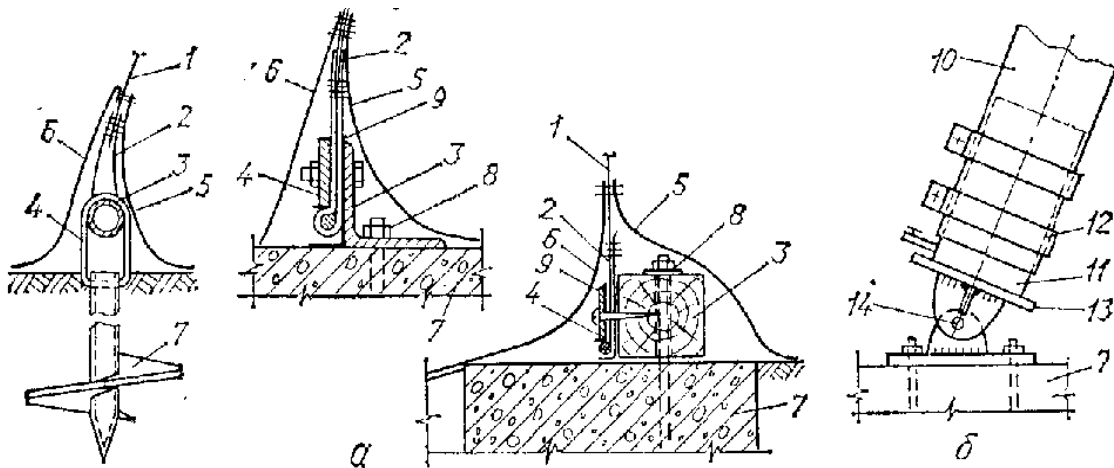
Кріплення пневмоконструкцій до фундаменту:
